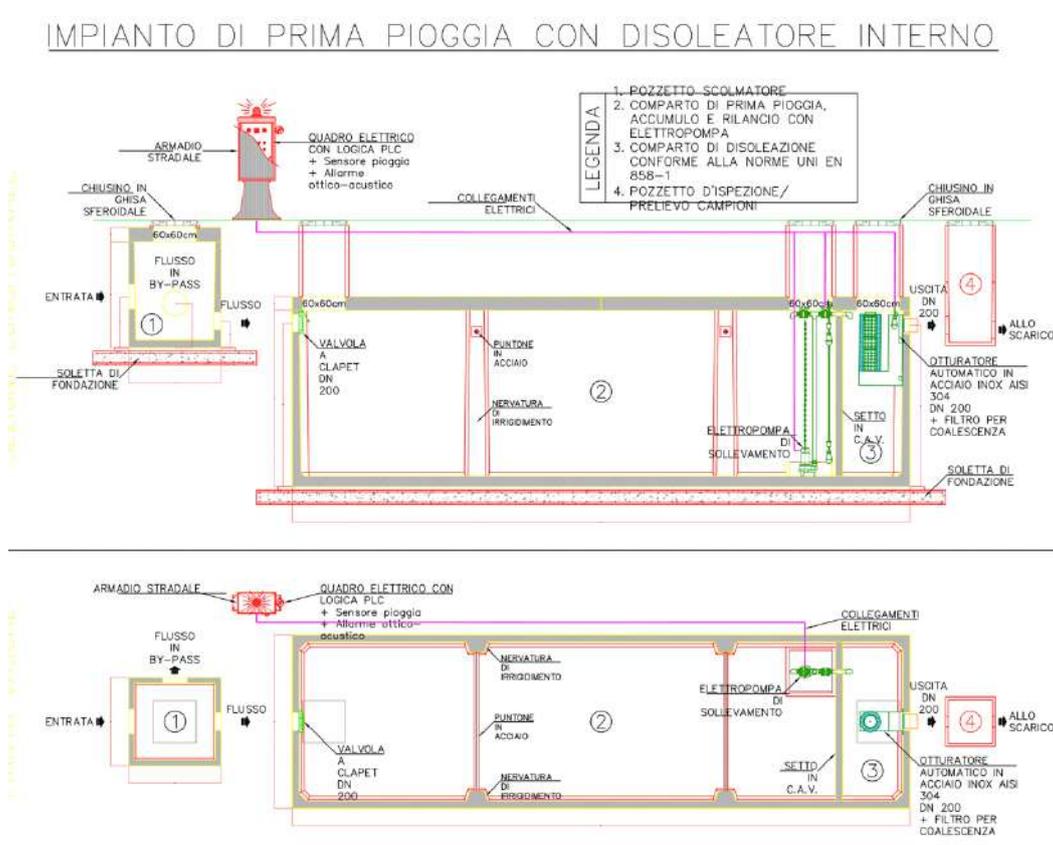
Impianto trattamento acque meteoriche, pianta e sezione
